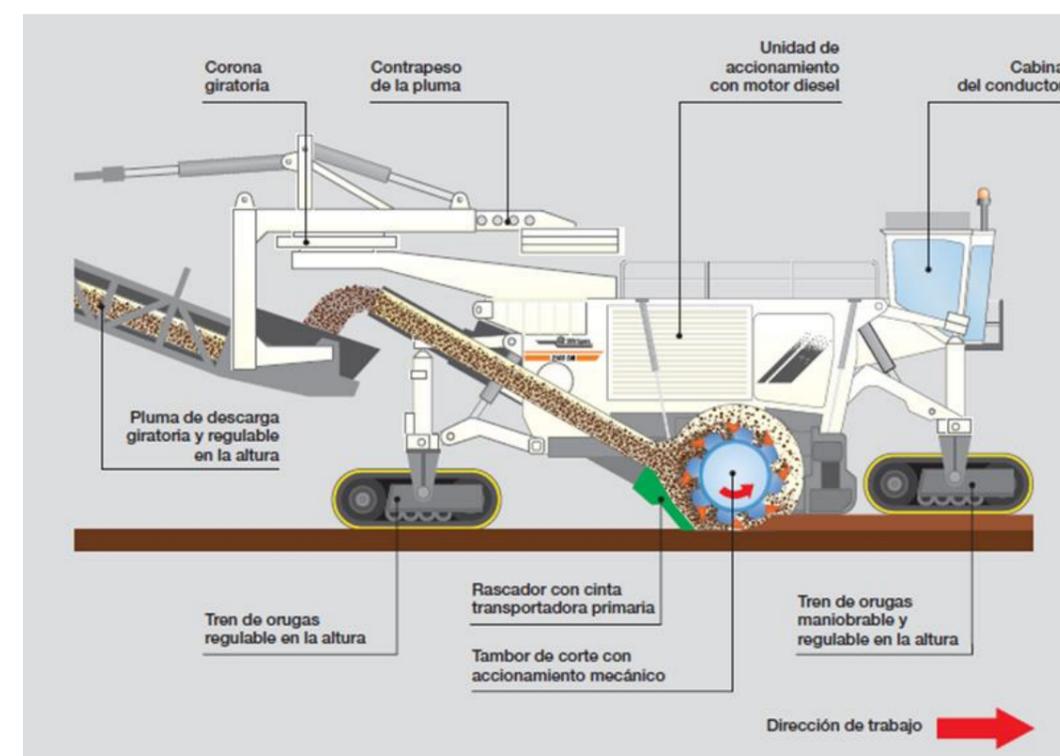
Máquina rozadora tipo para rebaje de plataforma. Fuente: WIRTGEN GROUP
